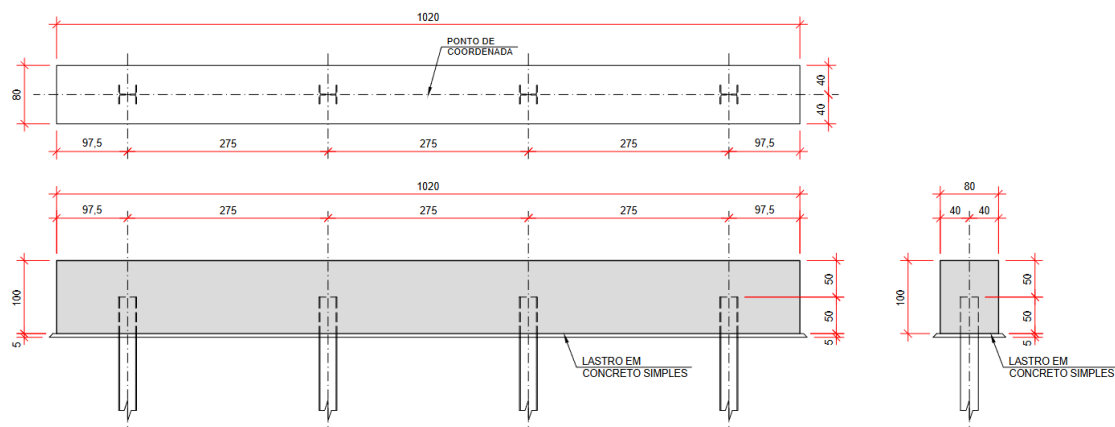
RAMO 400 - DISTRIBUIÇÃO DAS ESTRUTURAS DE FUNDAÇÃO (EIXOS E1 AO E9)
